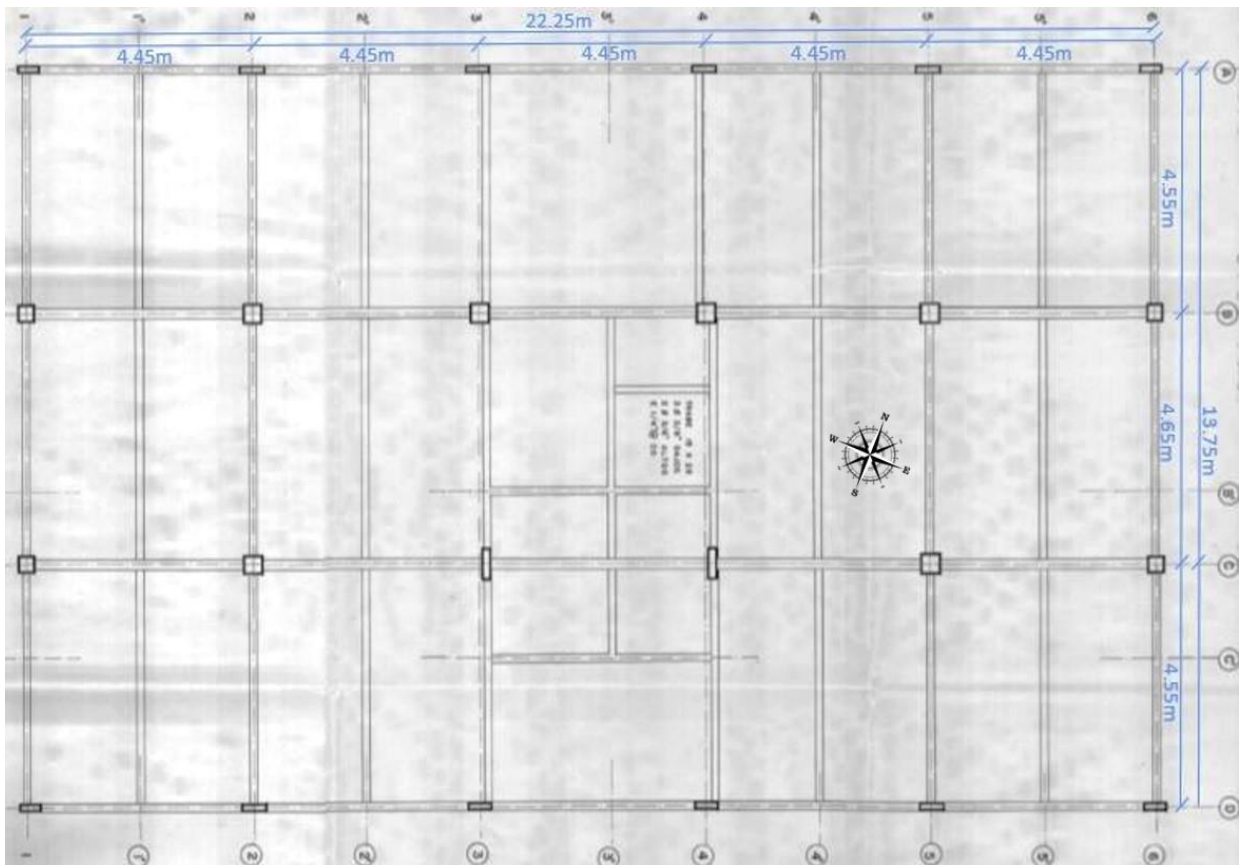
Planta piso tipo. (Carrillo, 2019b)
